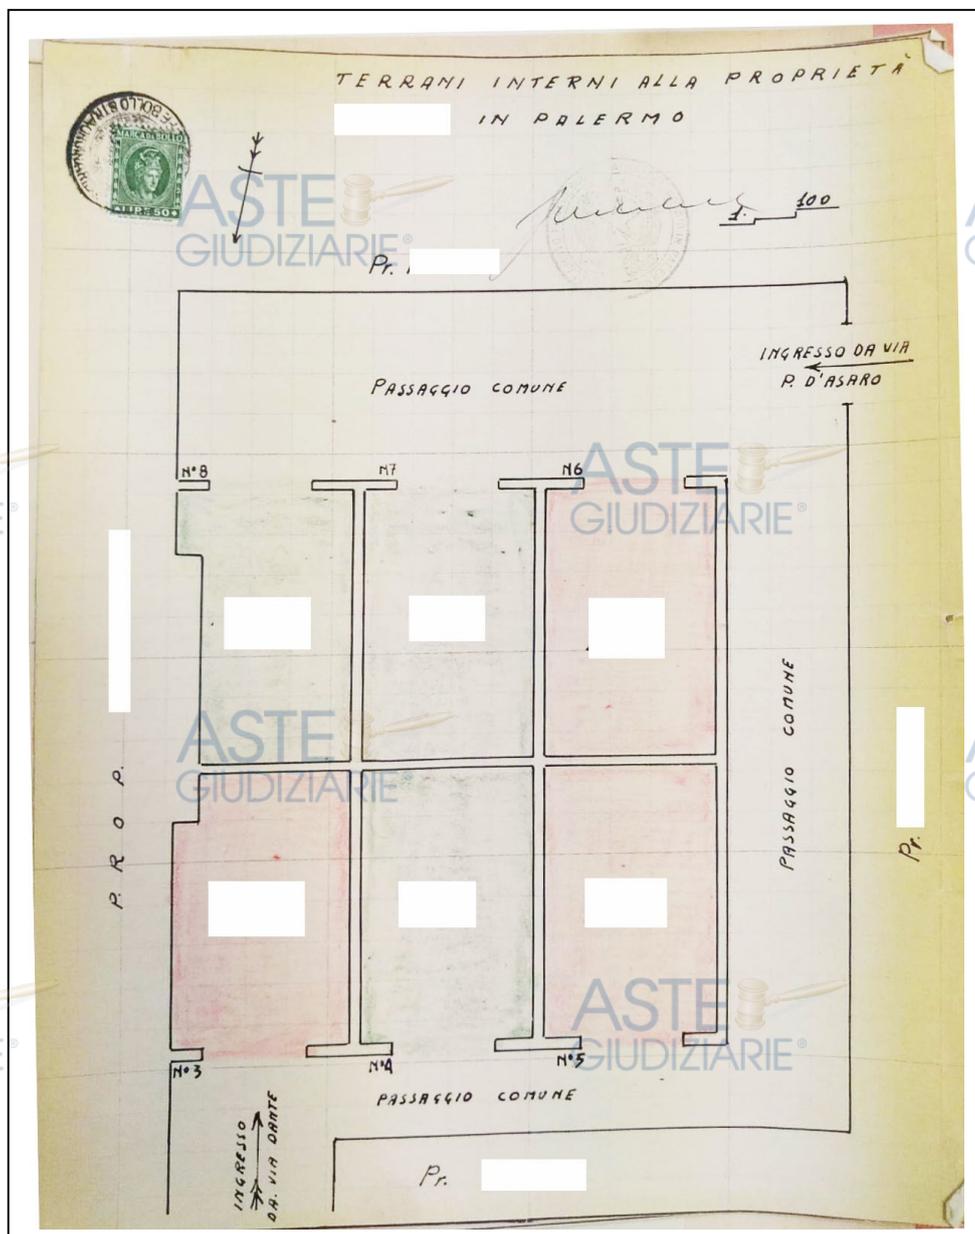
Estratto grafico di progetto allegato all'atto di divisione del 1962 estratto dal fascicolo edilizio.
